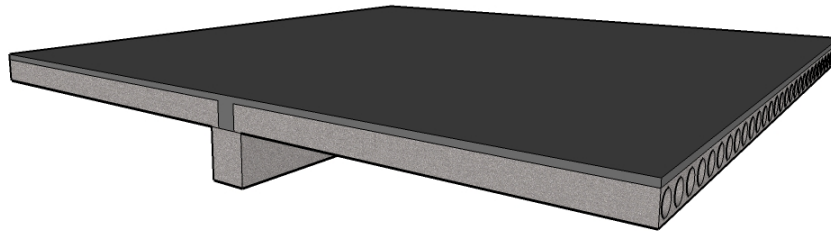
Vista tridimensional do modelo *viga em concreto armado composta*.
